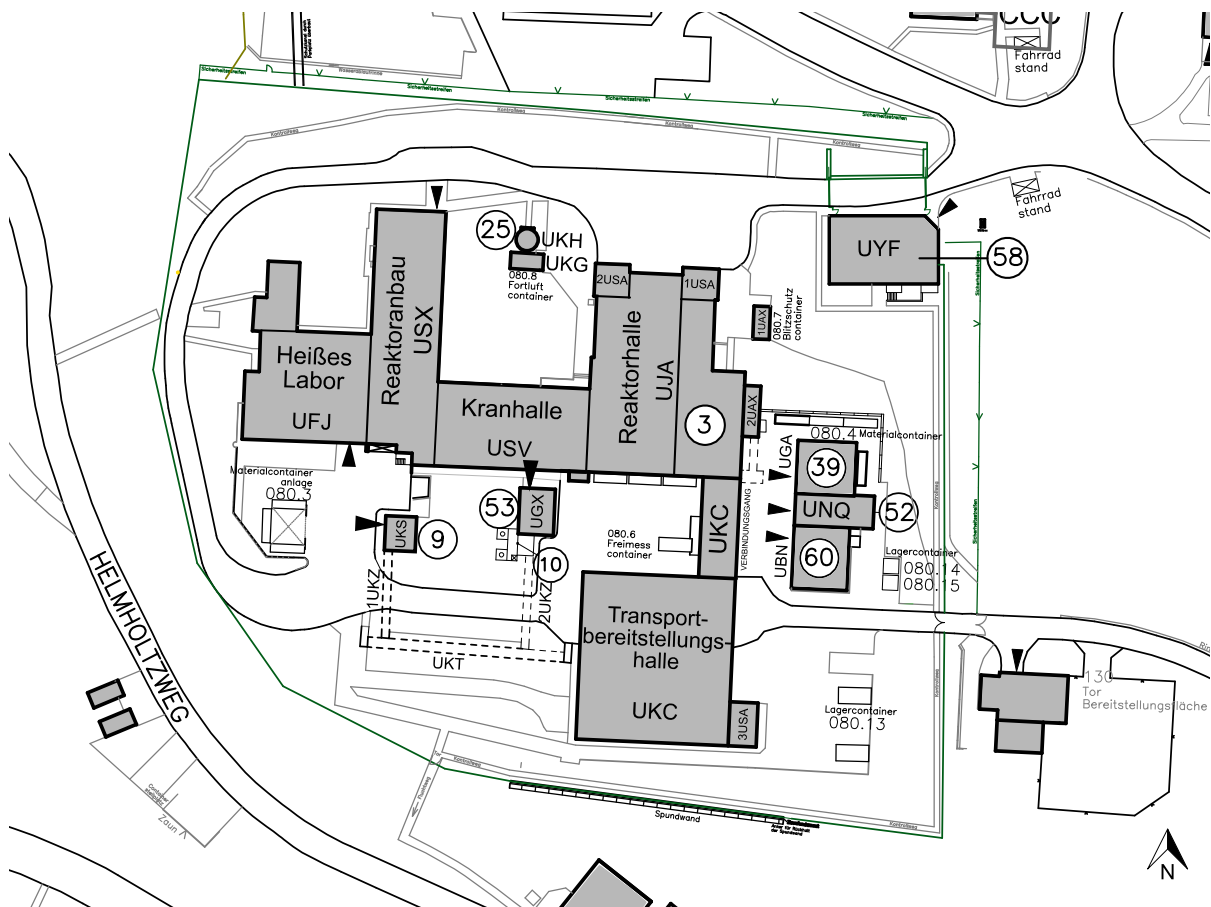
Lageplan Gebäude und Anlagenbereiche der FRG und des HL
